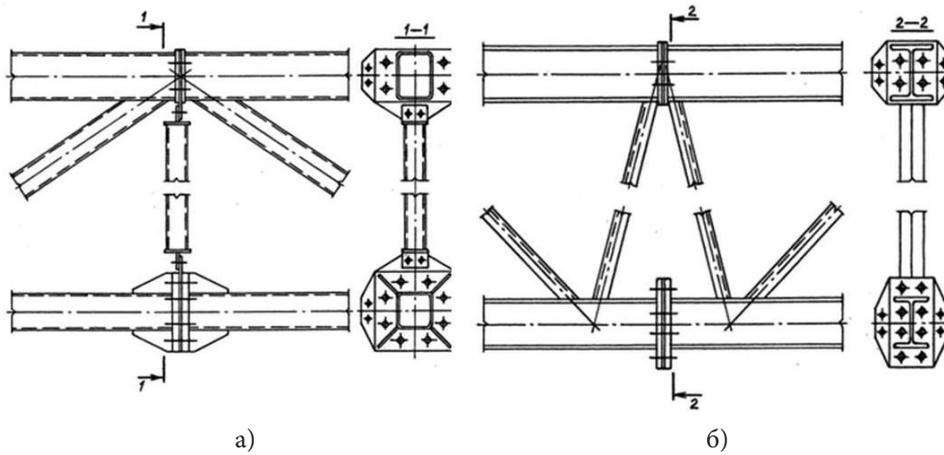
Схемы монтажных стыков стропильных ферм (ферм покрытий) с использованием фланцевых соединений на болтах: а – из замкнутых профилей; б – из открытых профилей
